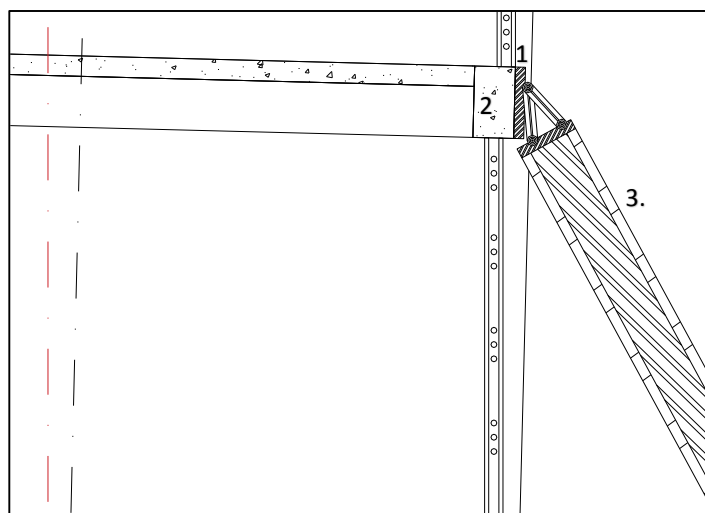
Ampliación detalle 3. Empuje en apoyo viga tercer nivel.
